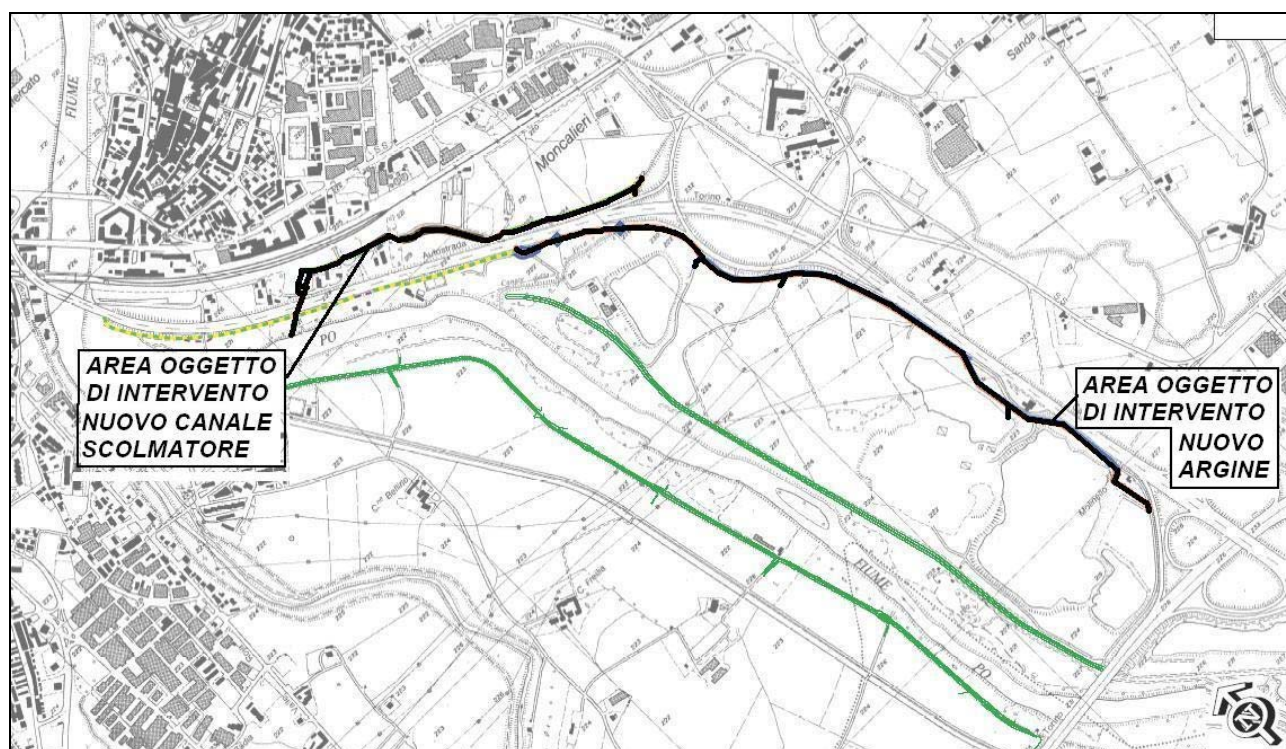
Planimetria generale della zona in studio con evidenziate le aree oggetto di intervento
